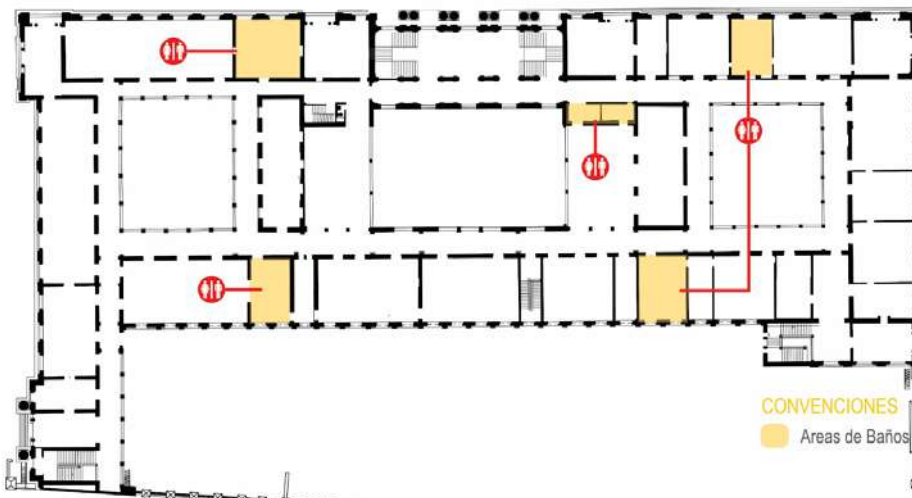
Esquema de ubicación de baños Planta Segundo Piso
